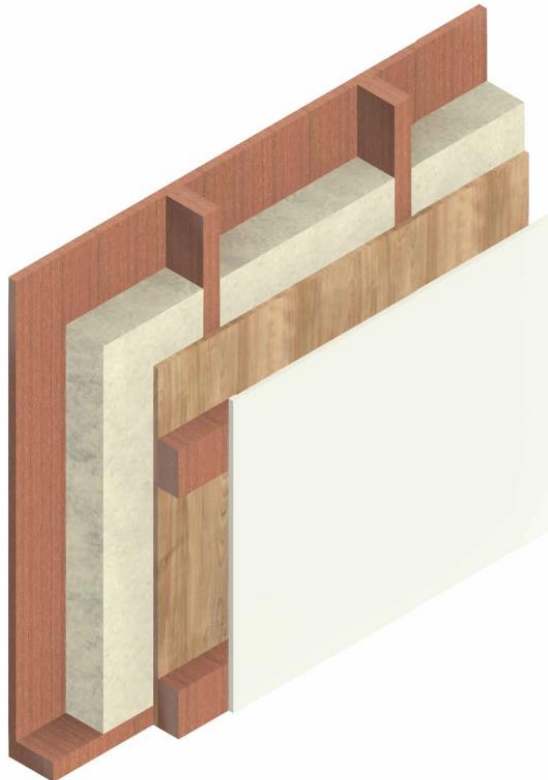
Ejemplo sistema constructivo con base a marco de madera
